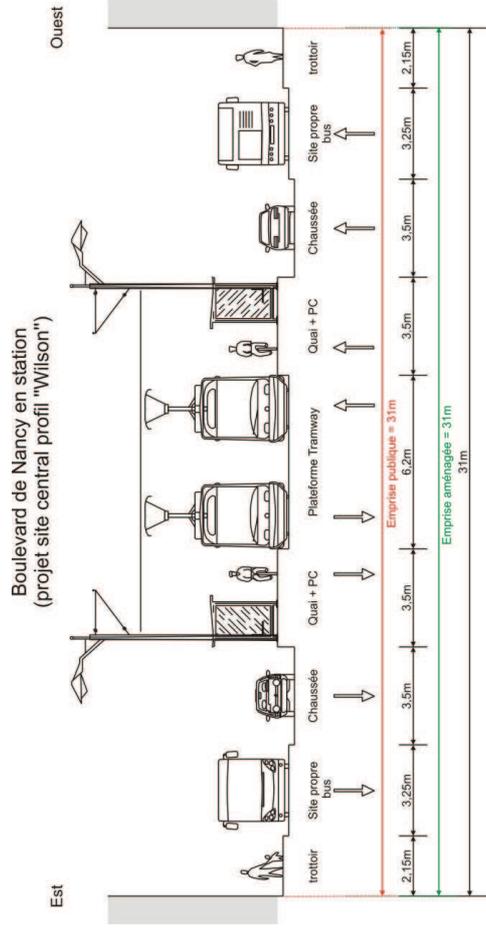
Aménagement projeté – coupe 31 – sur le boulevard de Nancy en station (variante profil "Wilson")
